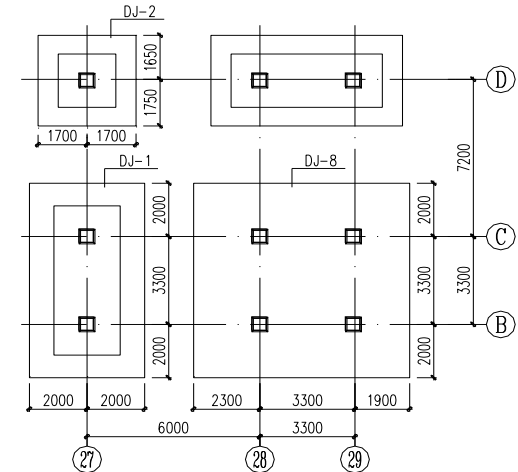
DJ-1, DJ-2, DJ-8 平面布置图
